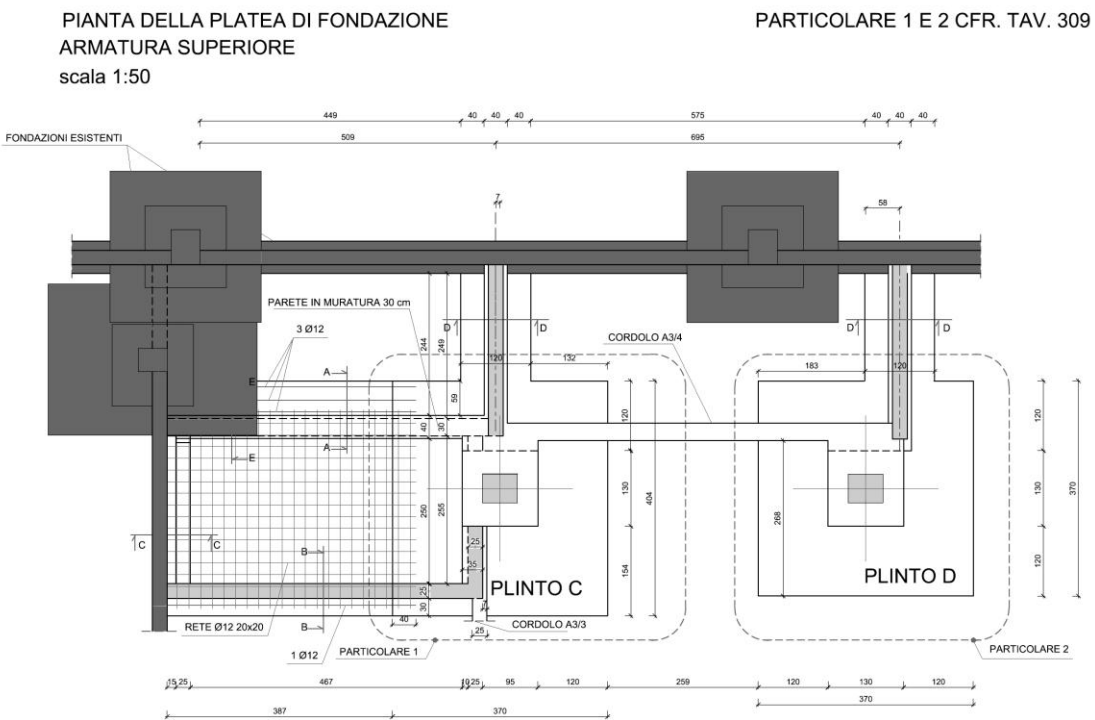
Particolare di A.2003.cap.us.T08 - Particolari fondazione nucleo 2 - Pianta platea
